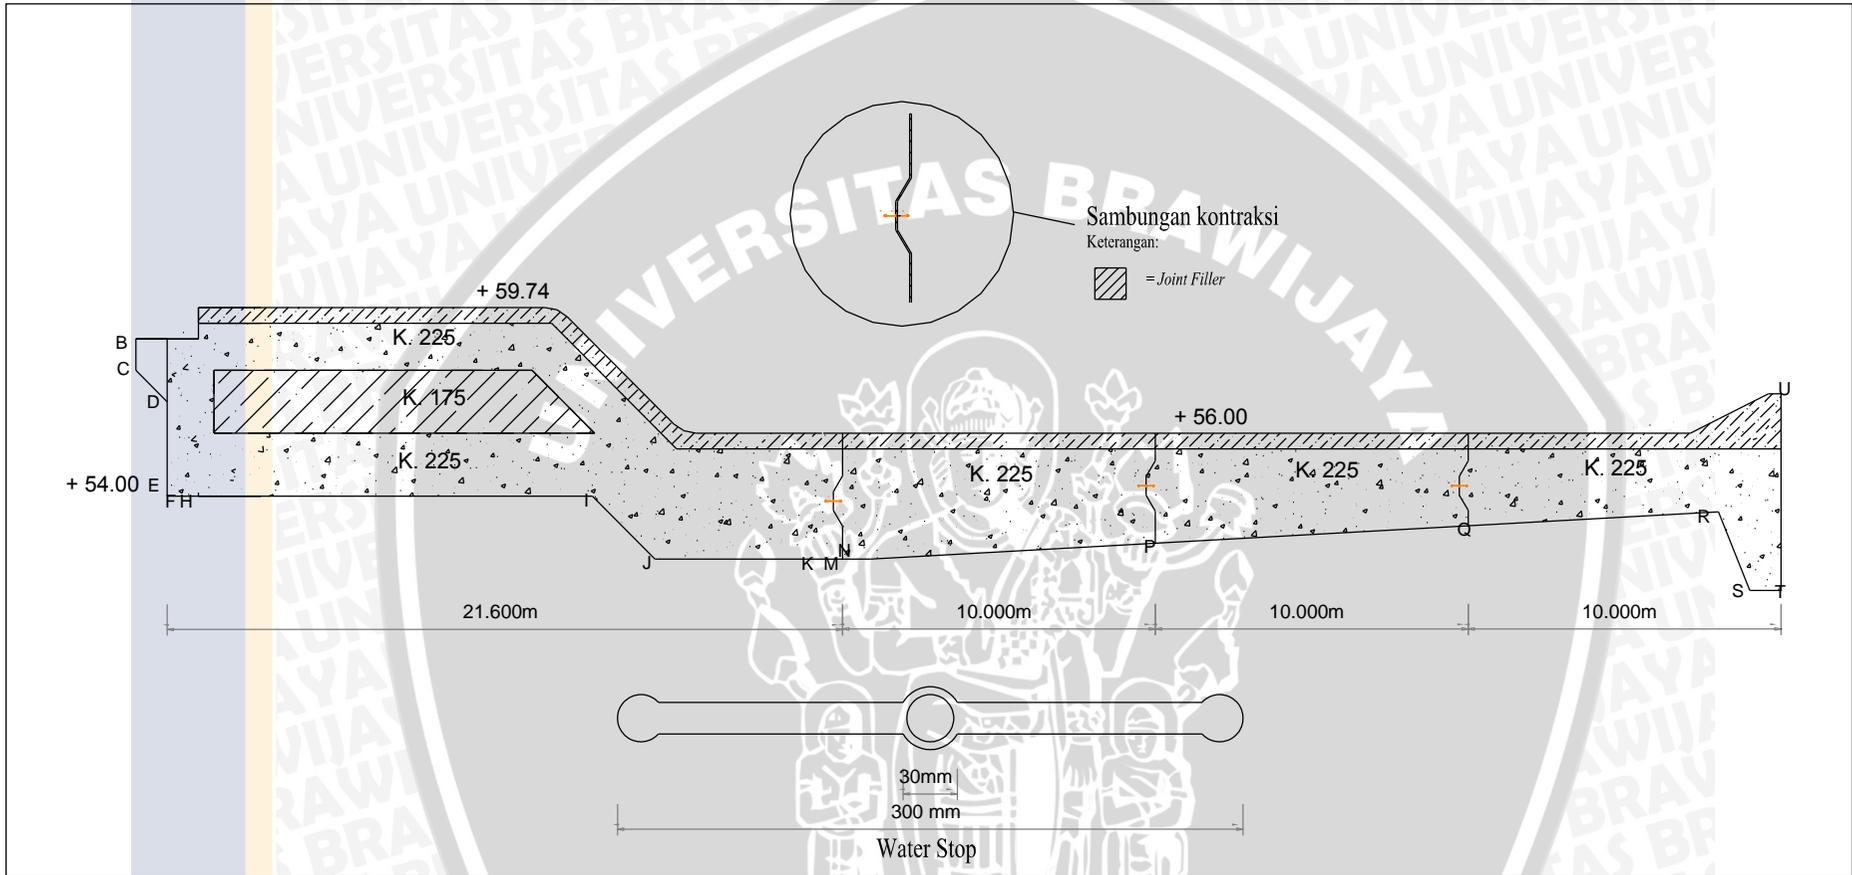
Sambungan Kontraksi Pada Bendung Gerak
